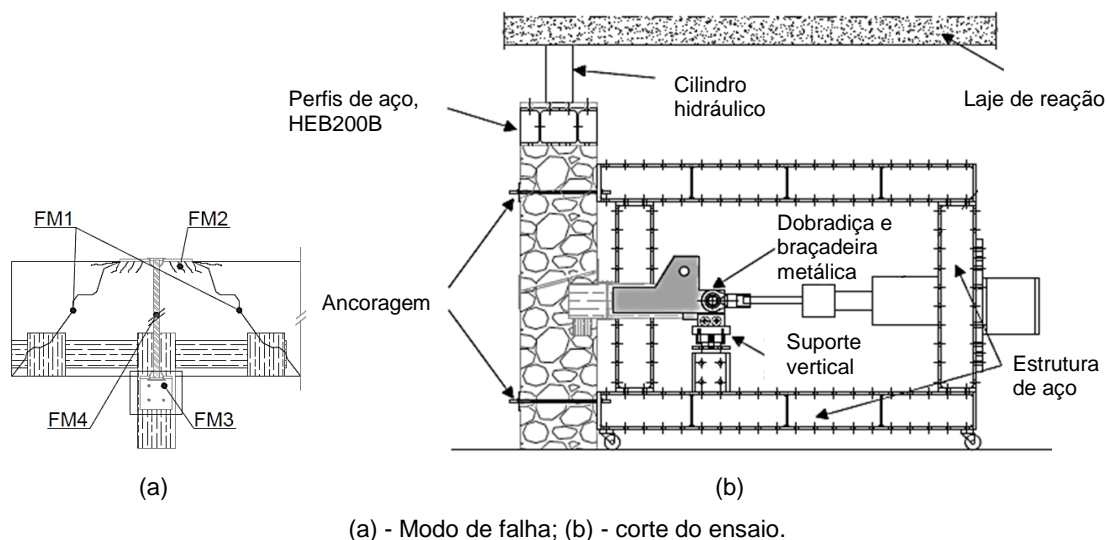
Ligação pavimento/parede (adaptado de Moreira, et al., 2014)
